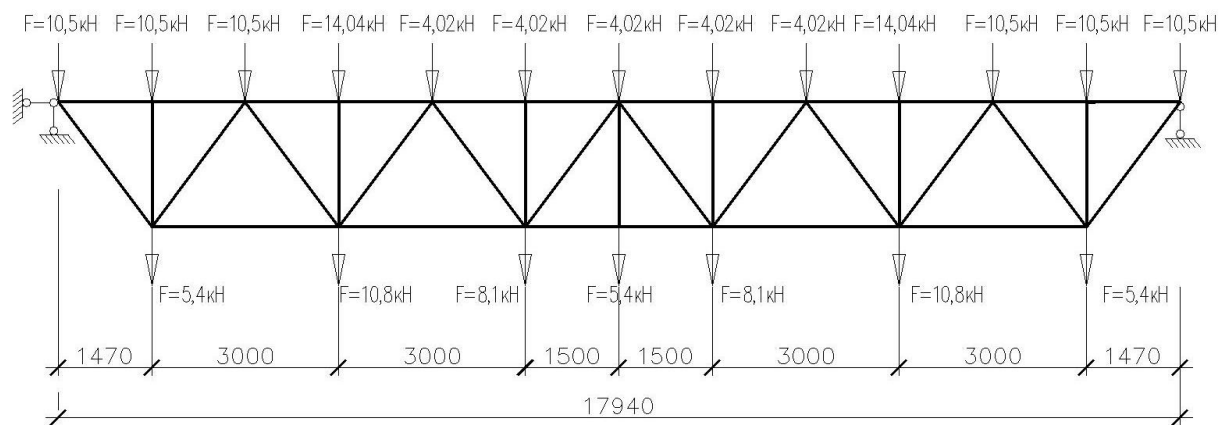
Схема приложенных постоянных нагрузок на ферму ФС1
